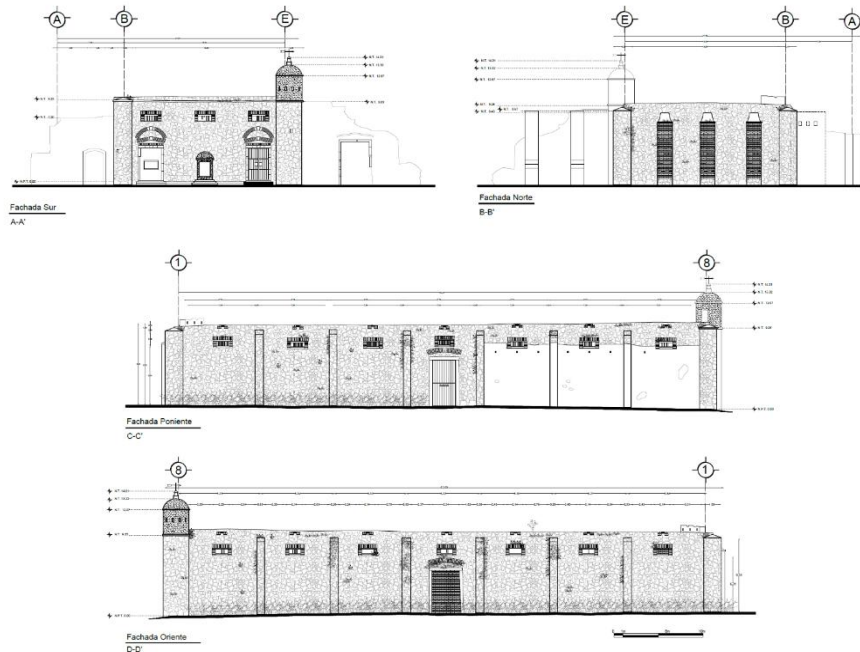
Fachadas donde se aprecian, accesos, ventanas y contrafuertes de la troje.
